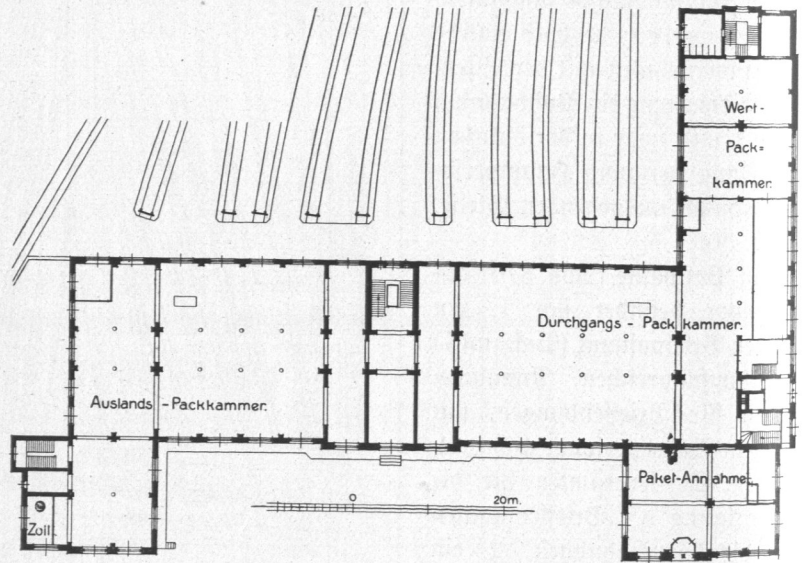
Postgebäude am Hauptbahnhof, Erdgeschloß, Grundriß.
